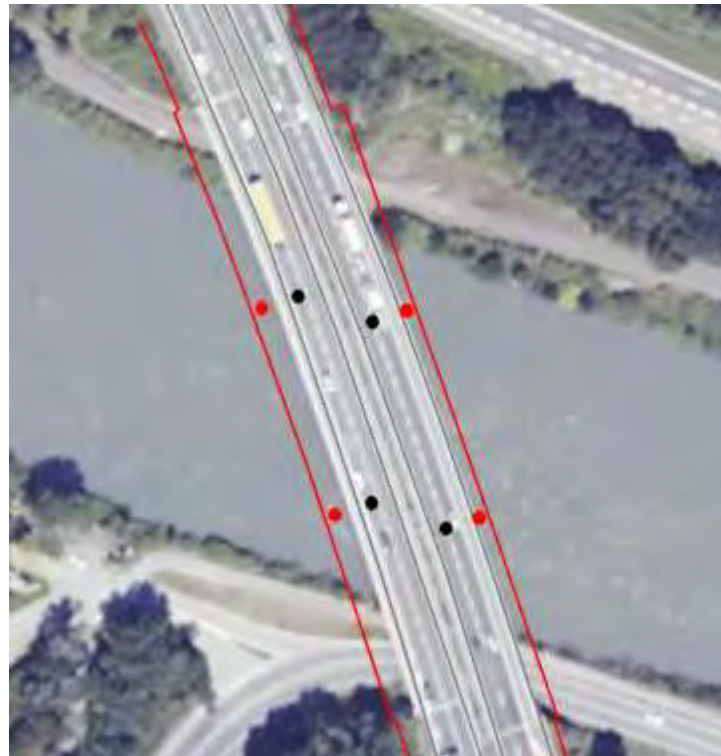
Plan schématique du projet d'élargissement du pont sur l'Isère
